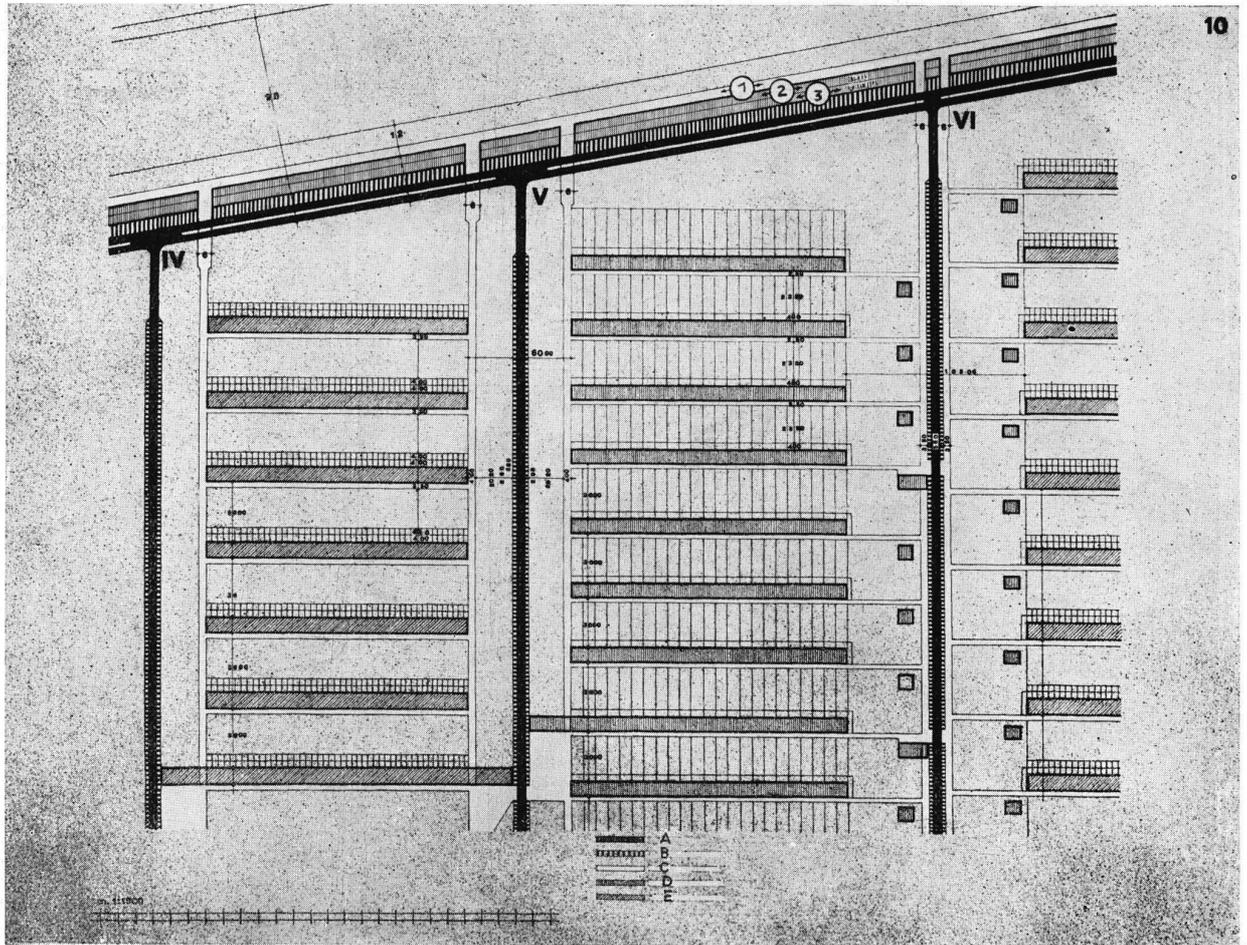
PLANO DE CAMINOS. TERRENO I
